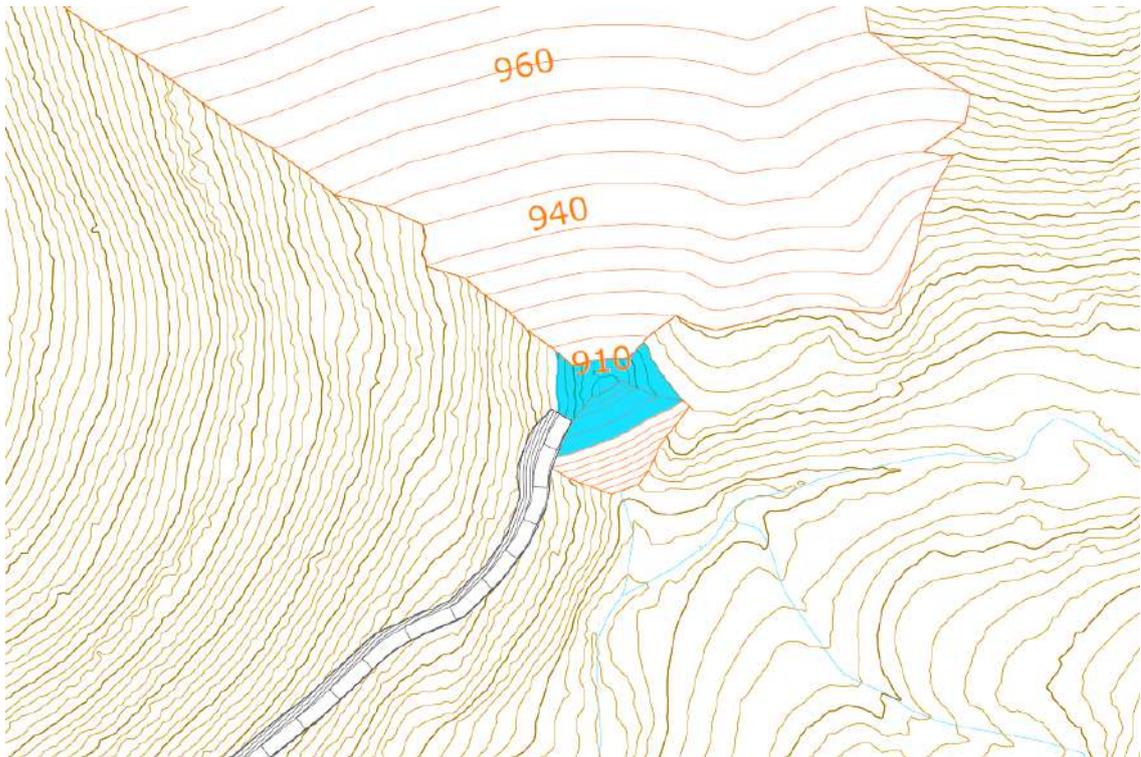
Planta de la balsa de decantación al pie de la escombrera norte.
